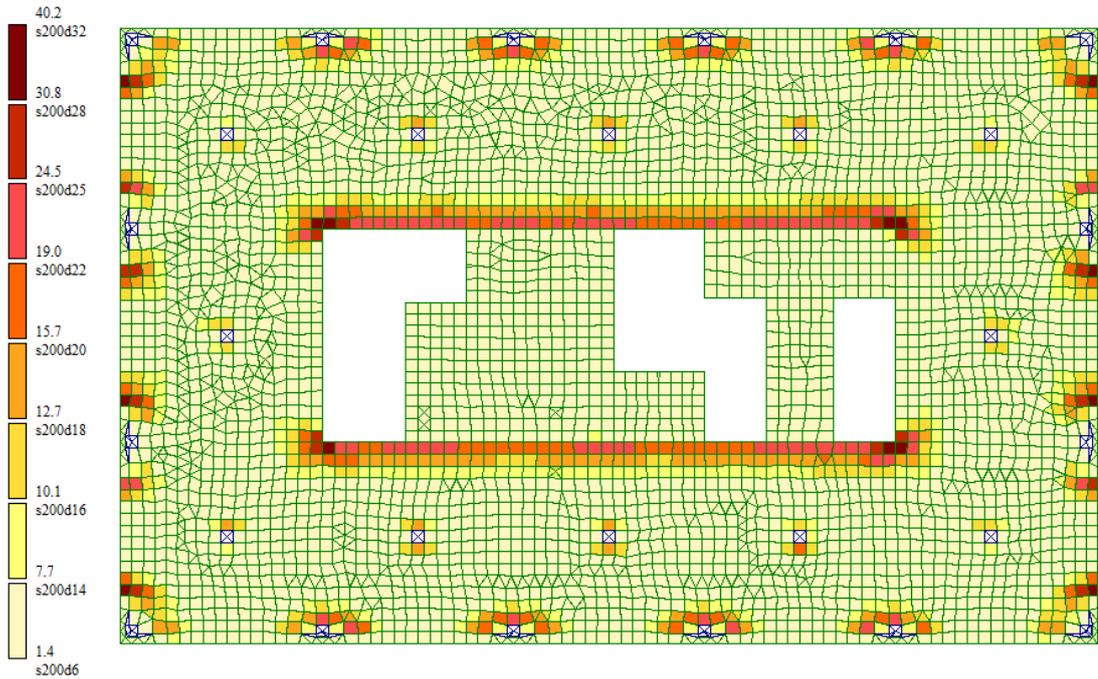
Схема армирования верха плит перекрытий по оси OY
